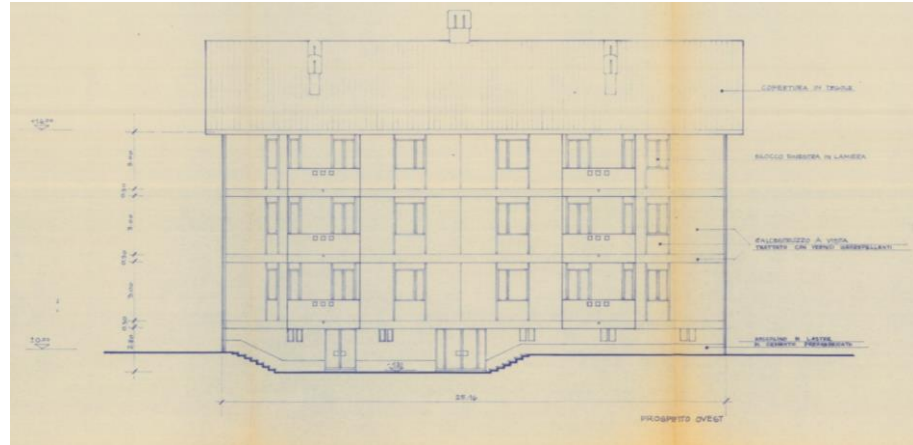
, Prospetto Sud-Ovest, scansione progetto originale
